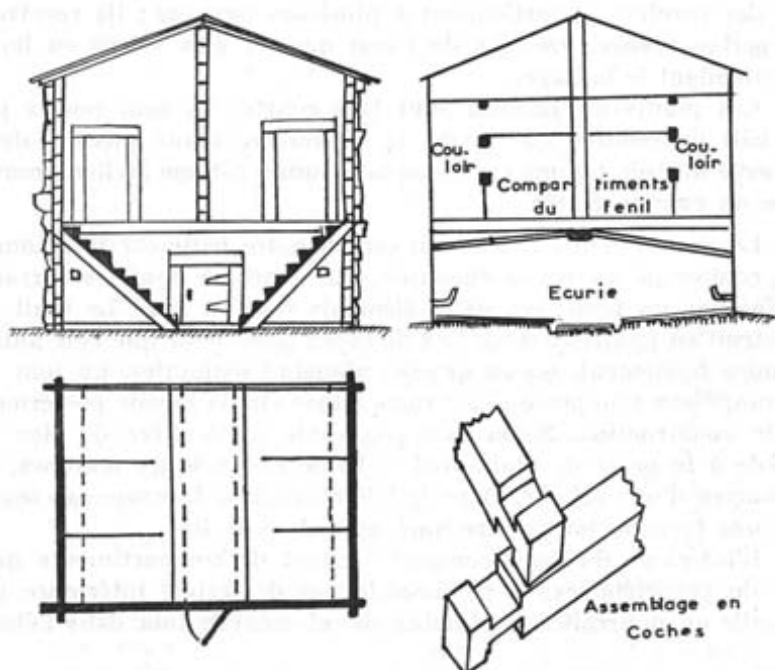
Ecurie-fenil : élévation, coupe, plan; détail d'un assemblage en coches. Longueur en façade : 7 m. Hauteur totale : 7,5 m.
